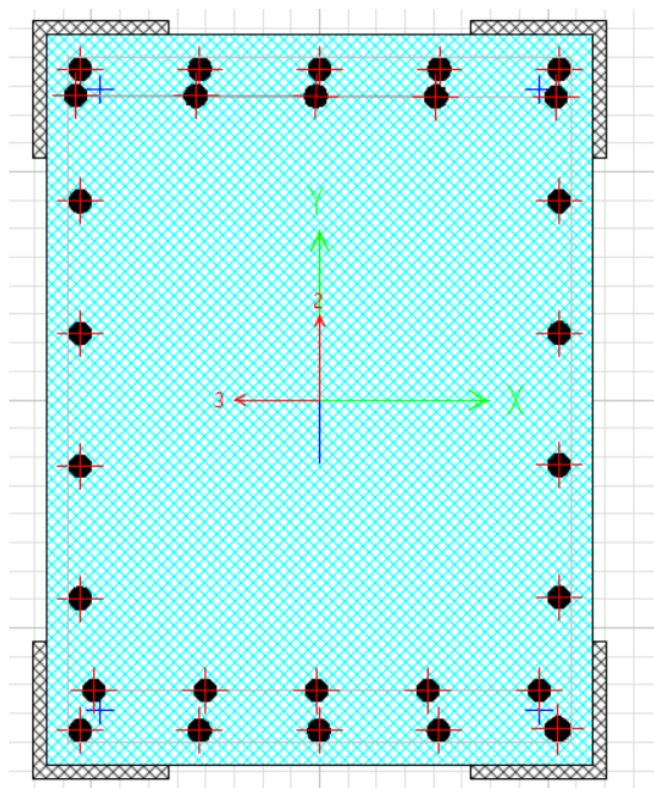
Columna pila reforzada con ángulos doblados de 150x150x5mm
